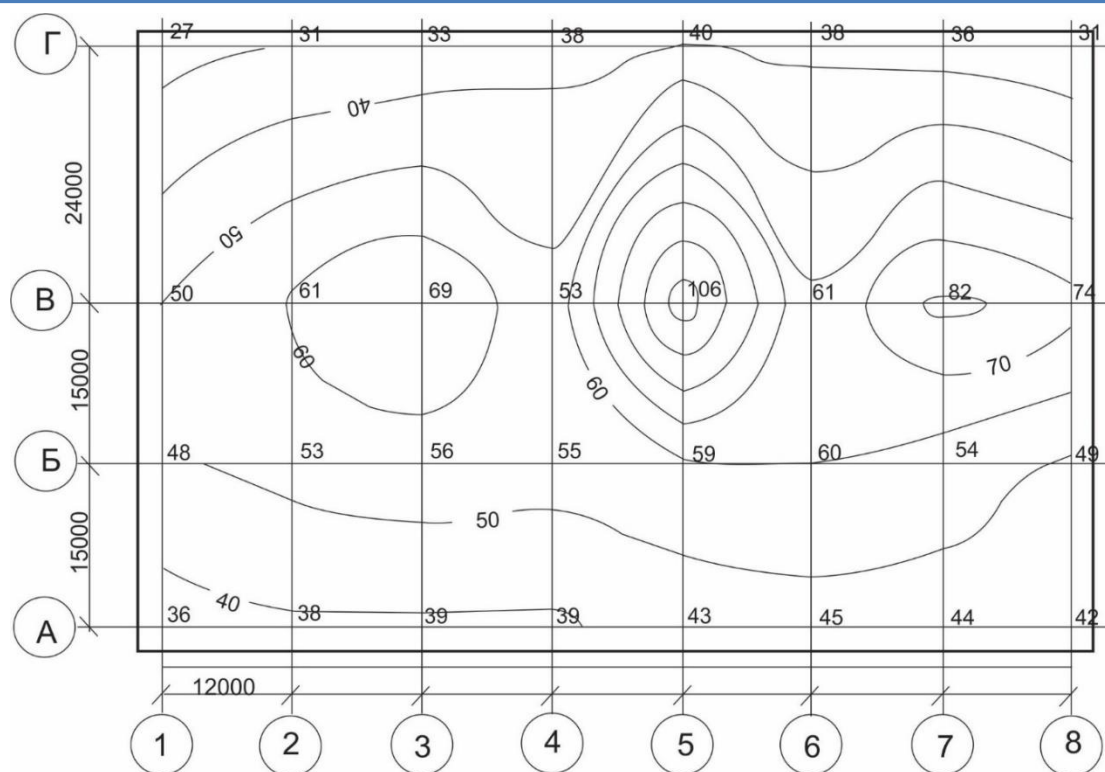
Графіки ліній рівних осідань фундаментів колон каркасу будівлі нового цеху
